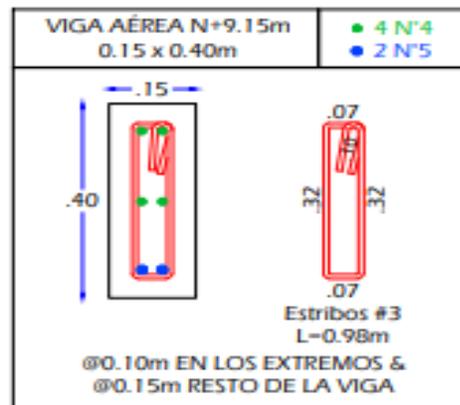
despiece de estribos de vigas secundarias plano estructural Wiedii
